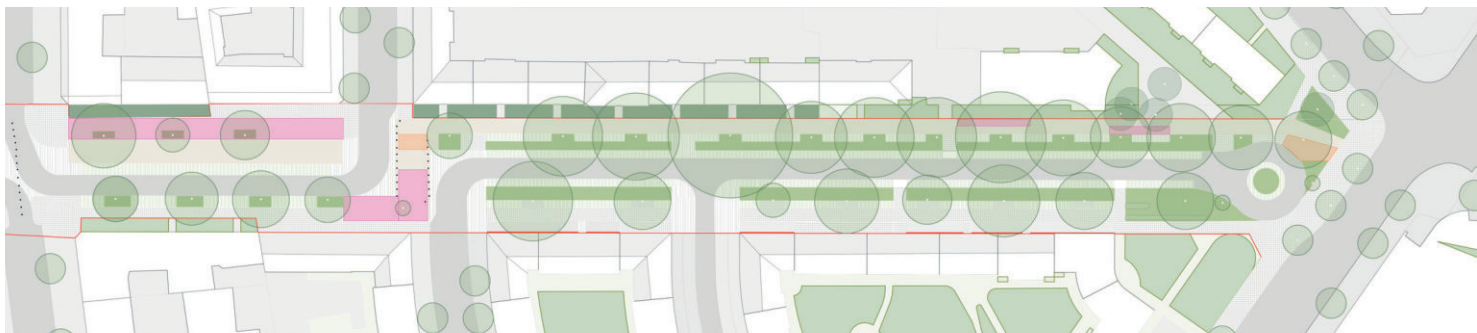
Lageplan Konzept *Menschliche Bellermannstraße*, gedreht, Grundlage ALKIS
